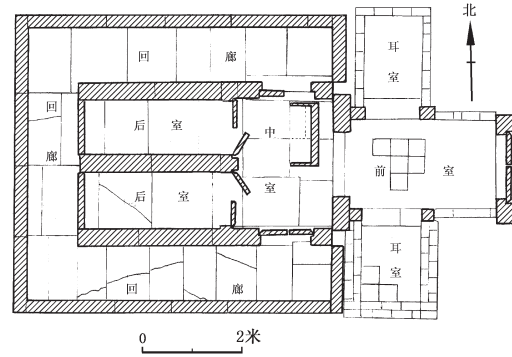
河南省唐河新店汉墓平面图 (1/150)
